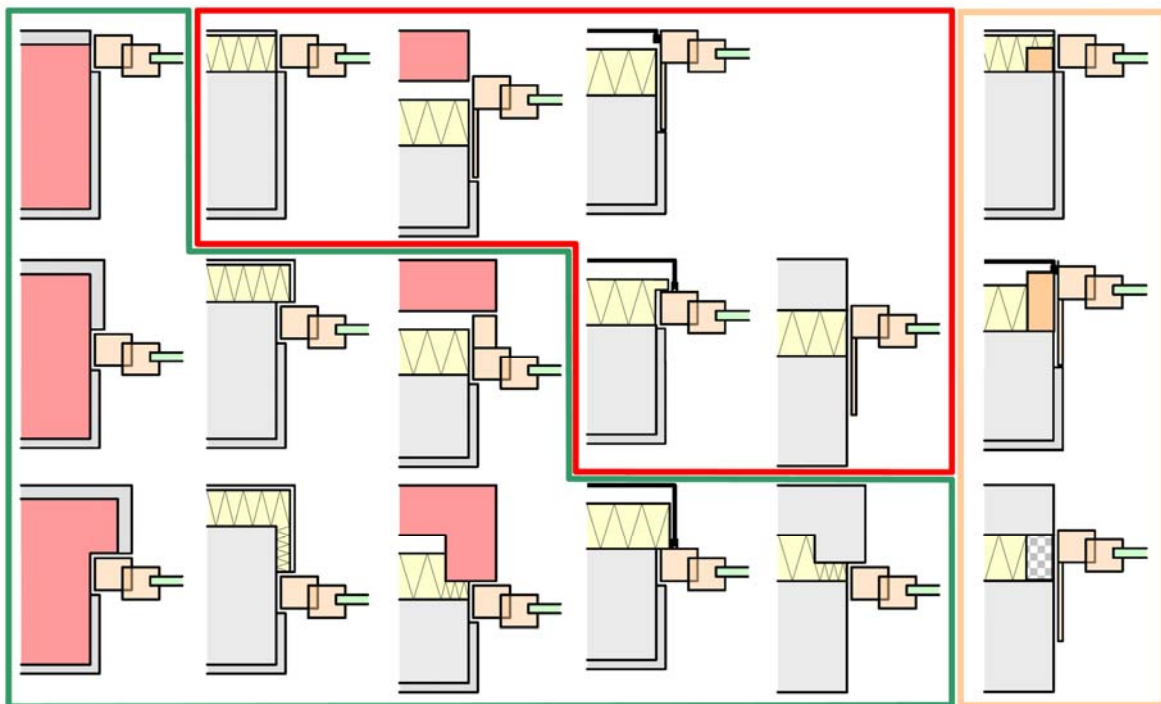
Angaben zu Einbausituation im Leitfaden zur Planung und Ausführung der Montage von Fenstern und Haustüren [6]
